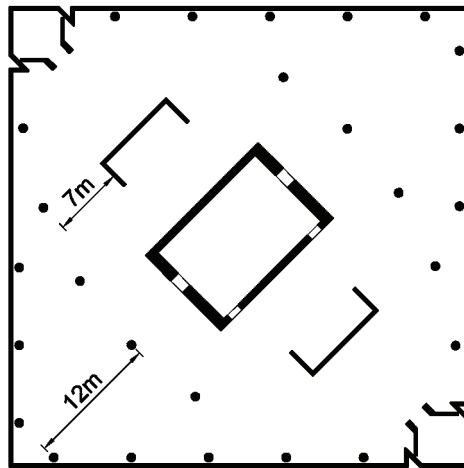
Esquema con la disposición de apoyos y huecos de paso en un forjado tipo.
